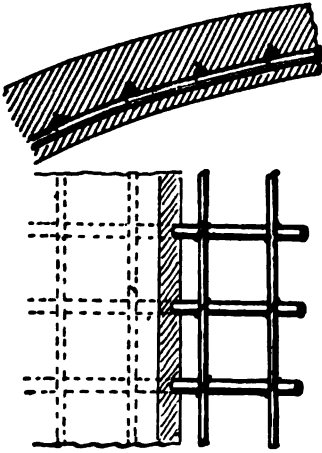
Schema einer Eisen-Beton-Konstruktion.
